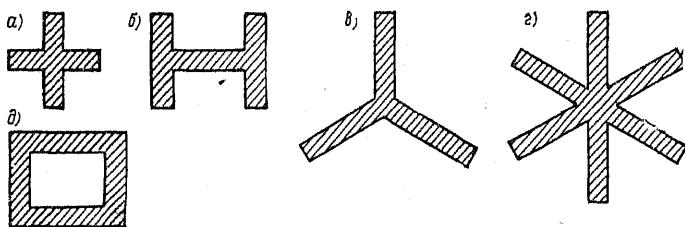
Глубокие опоры (в плане), выполненные методом «стена в грунте»
